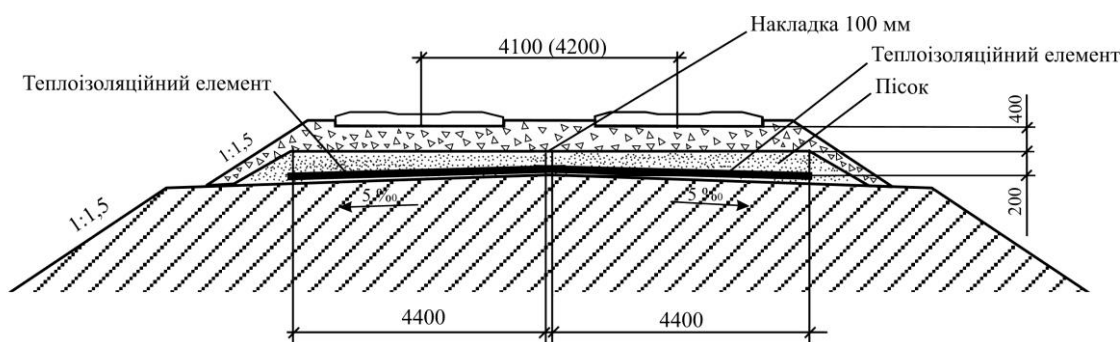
Конструкція земляного полотна із захисним шаром піску та теплоізоляційним елементом
